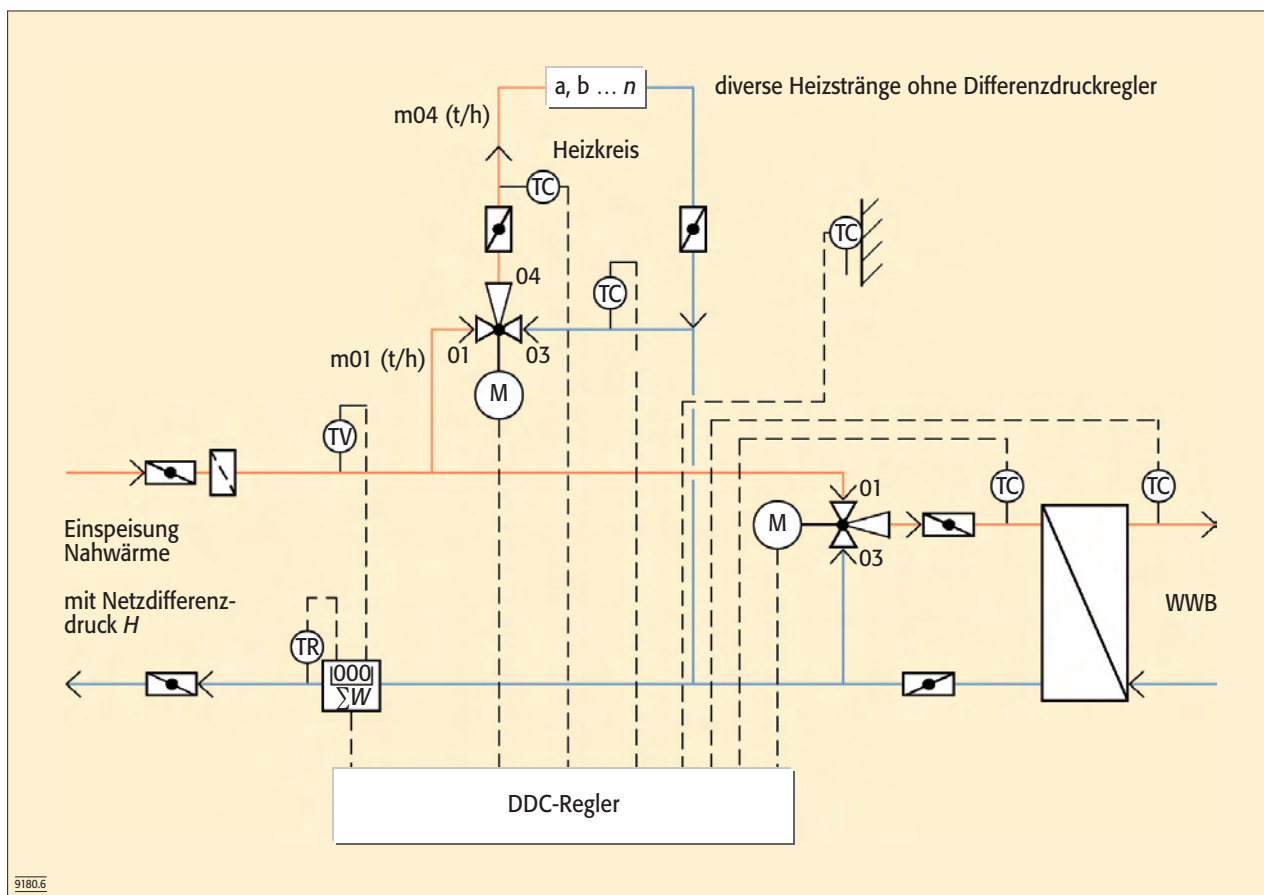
Gebäudeanlage mit nachhaltigem Aufbau
